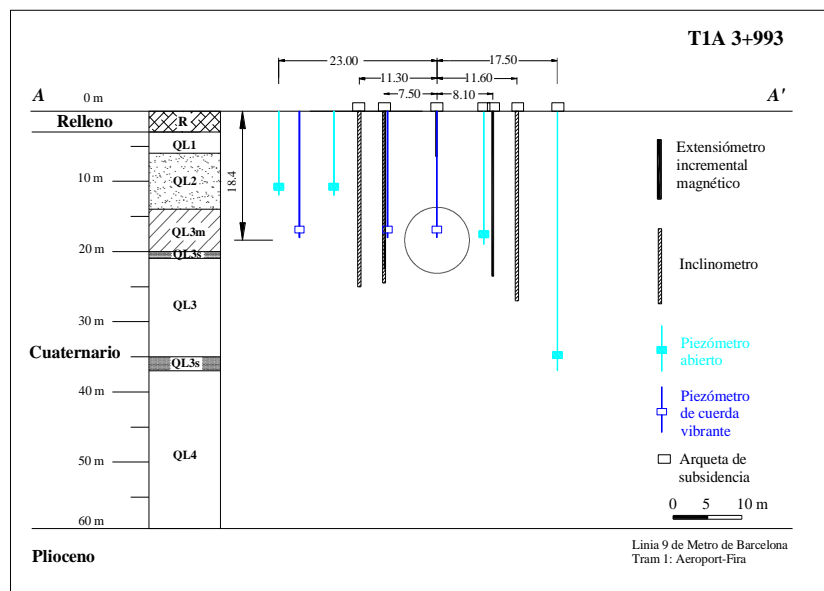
24. Perfil de la instrumentación instalada en la sección de control T1A PK 3+993
